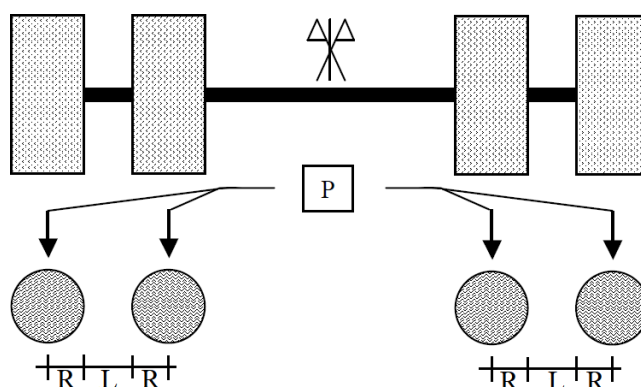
Configuração e esquematização geral adotada para a ação de um eixo-padrão sobre o pavimento (adaptado de Branco et al, 2011 e Oliveira, 2001)
